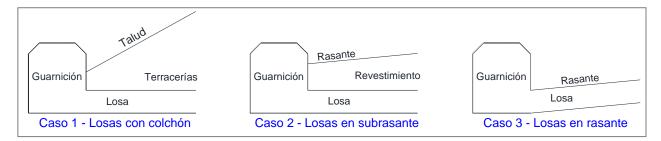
Guarniciones tipo para losas de concreto reforzado, Ilustración, 2018
